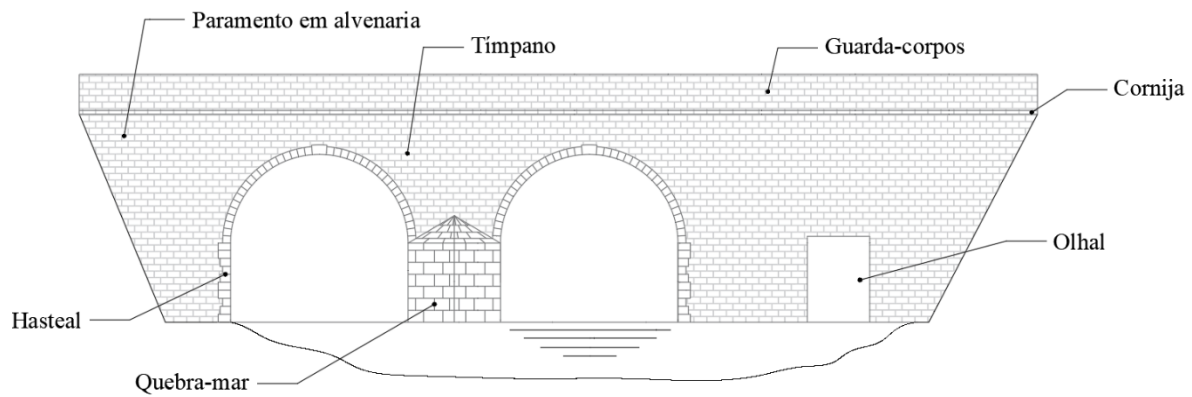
Denominação dos elementos constituintes de obras de arte em arco de alvenaria de pedra (alçado)
